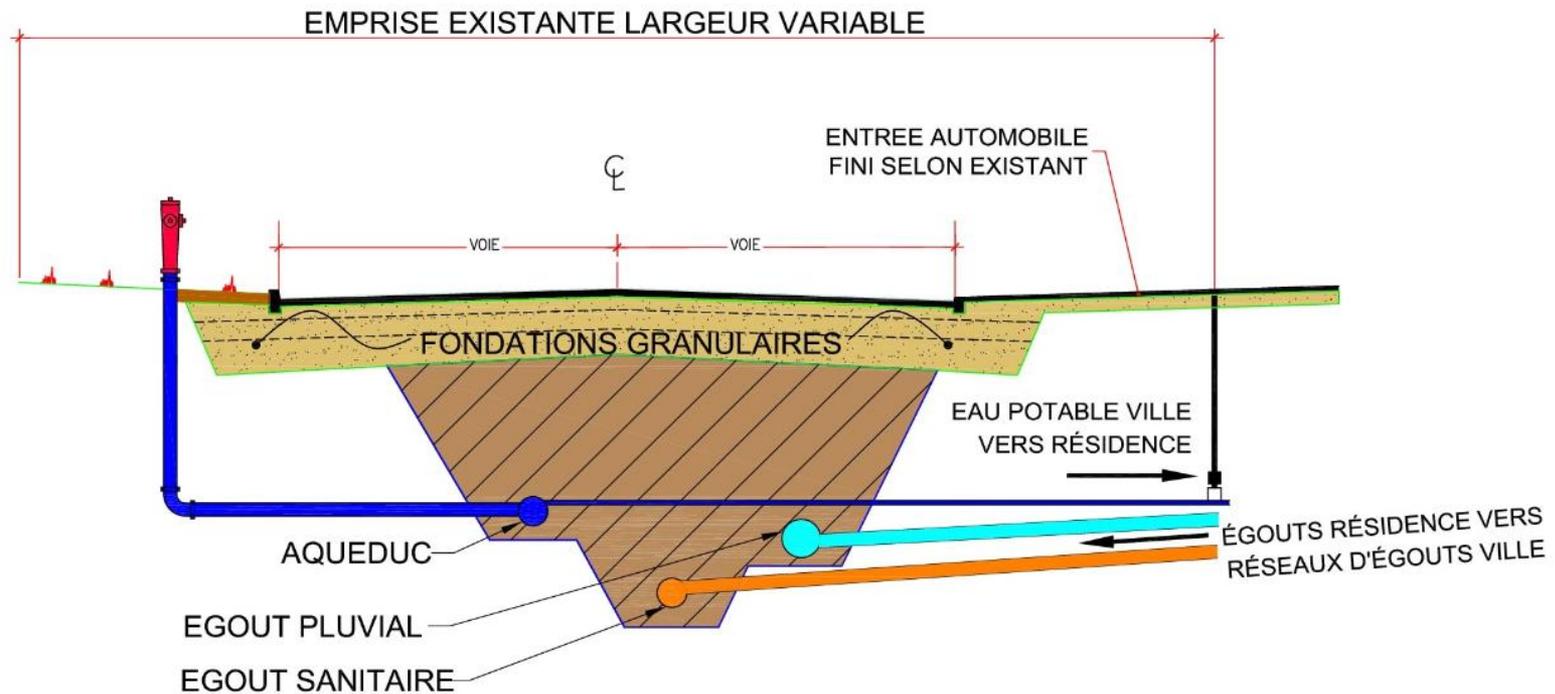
FIGURE: RECONSTRUCTION DE LA CHAUSSÉE
